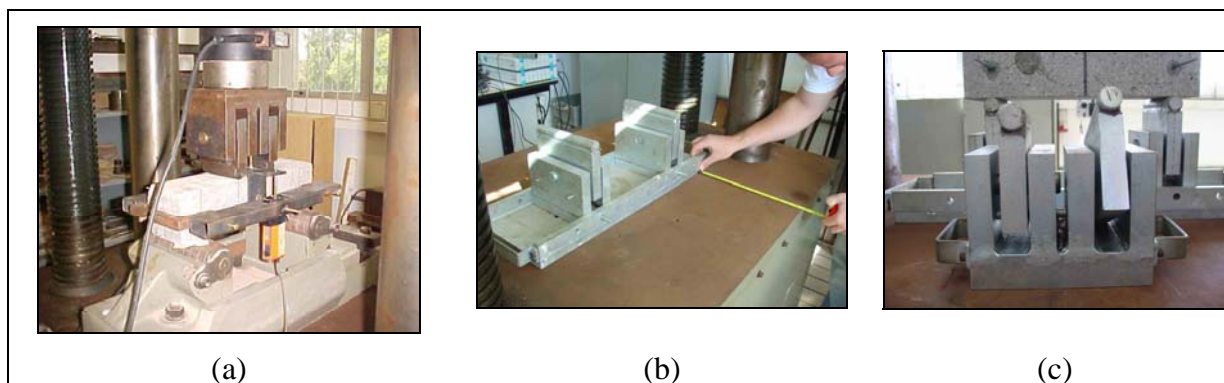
(a) Aparato disponível na prensa Shimadzu para apoio da viga; (b) aparatos desenvolvidos para o apoio da viga e (c) para a aplicação da carga.
